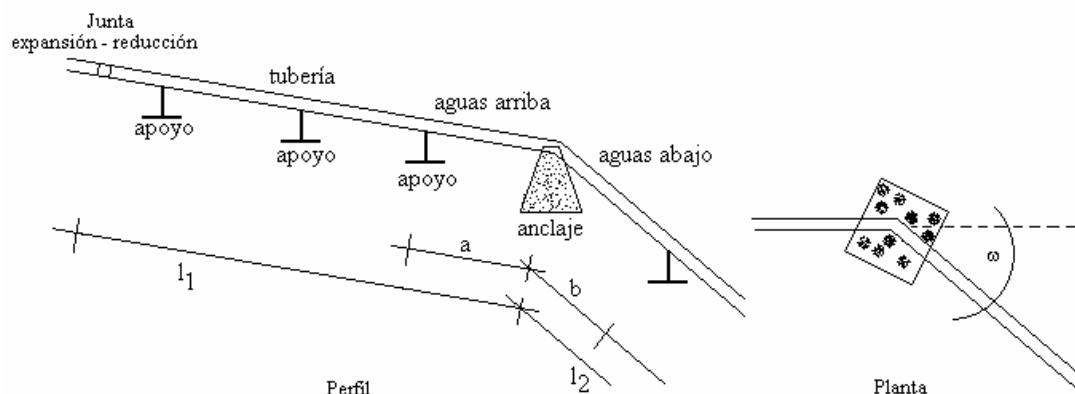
Perfil y planta de una tubería con doble cambio de alineación.
